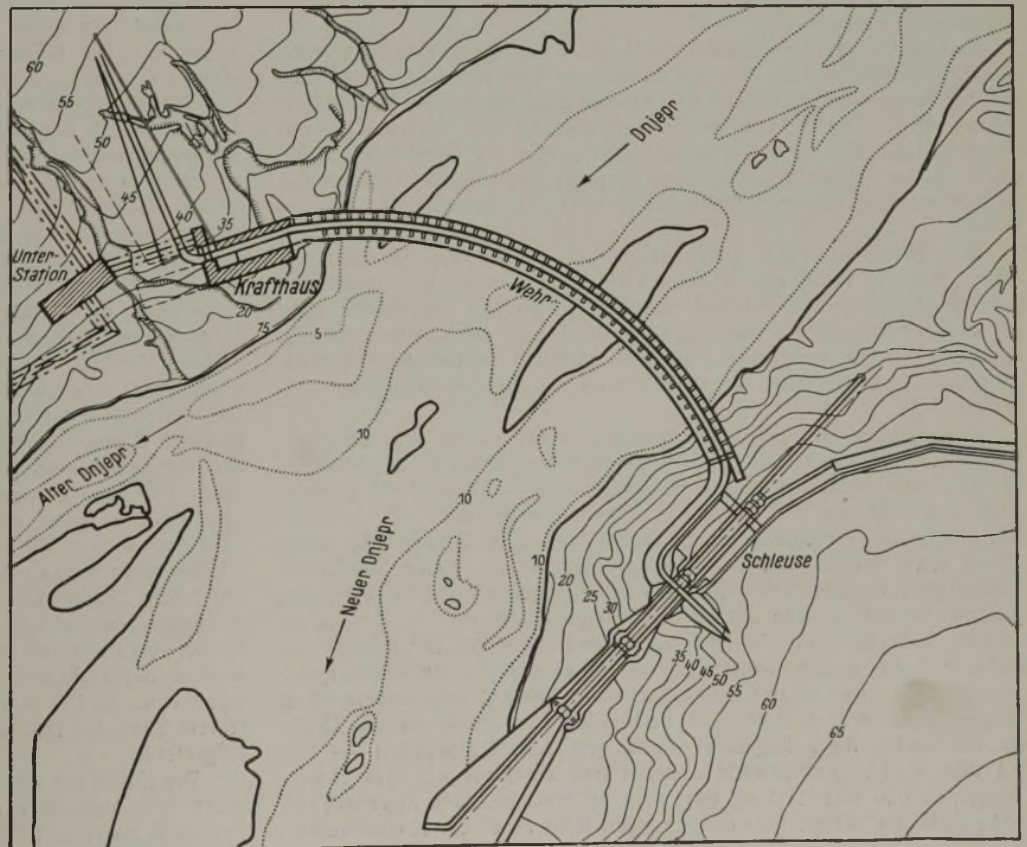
Lageplan der Anlage Dnjeprostroi.
